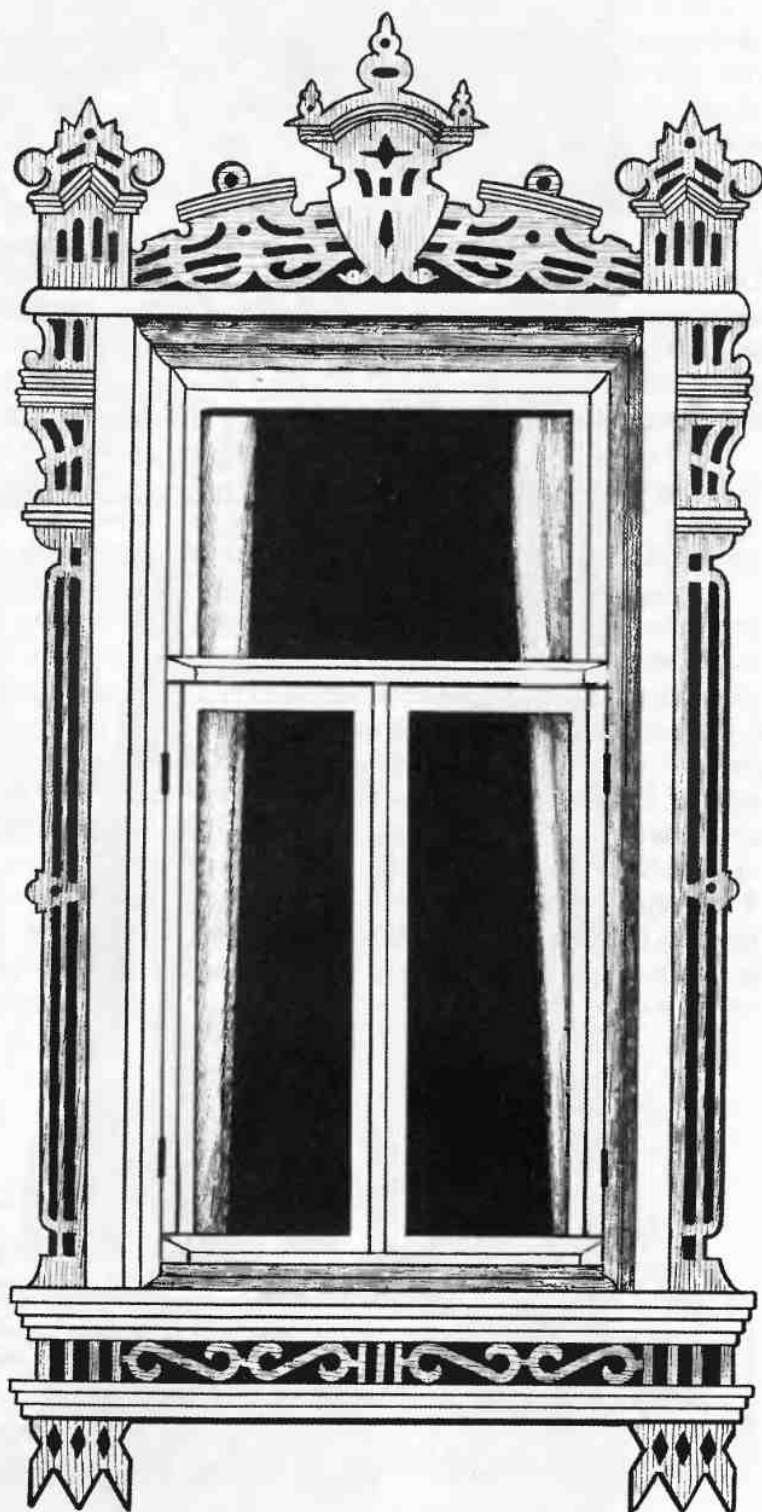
Наличник, декорированный деталями из досок с прорезной резьбой и накладными планками
